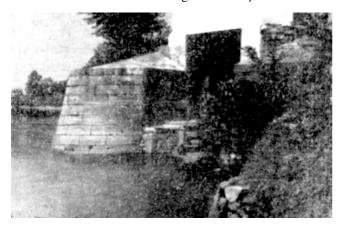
Priza cu stația de pompare pe canalul Mureșel
